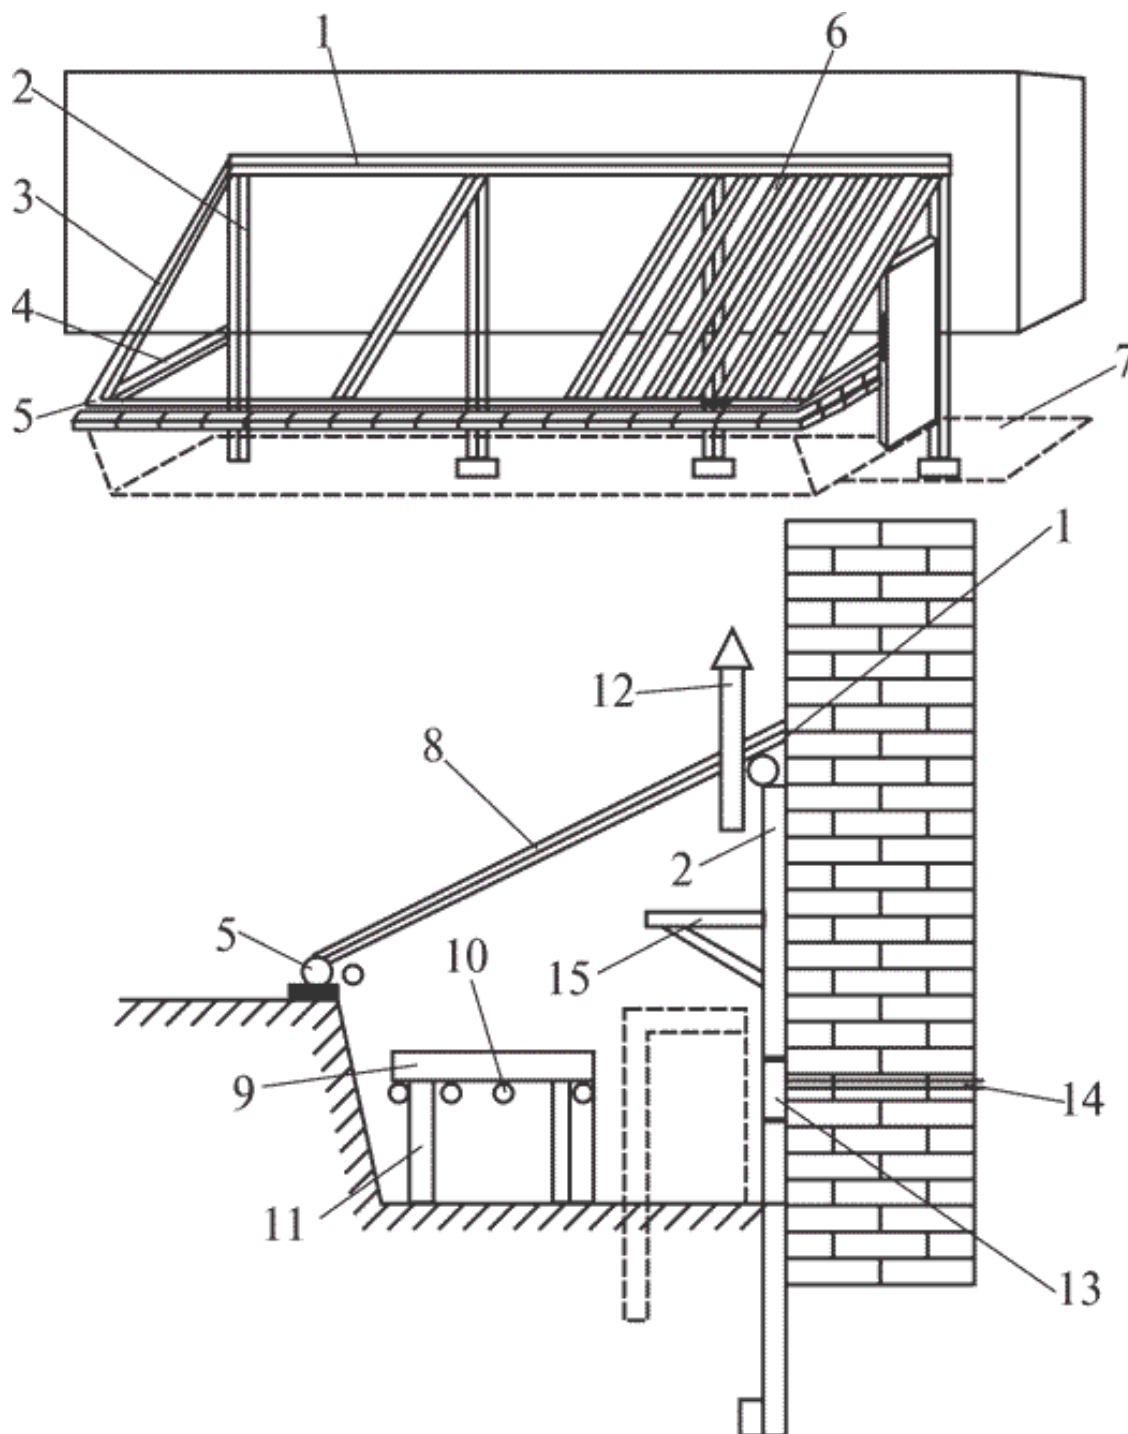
Пристенная теплица: 1 и 5 – лежни, 2 – столбы, 3 – поперечные бруски, 4 – поперечины, 6 – шпросы, 7 – место под тамбур, 8 – остекленный скат, 9 – стеллаж, 10 – трубы отопления, 11 – стойки под стеллаж, 12 – вытяжная труба, 13 – радиатор отопления, 14 – ввод труб отопления и водопровода, 15 – навесная полка
